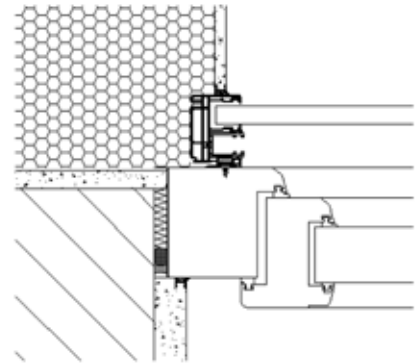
Anschlussdetail mit Führungsschiene AK-FLEX
